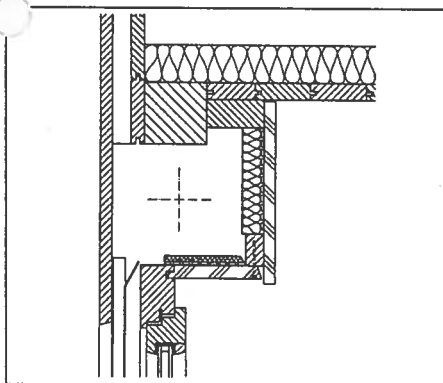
Schalltechnisch richtig ausgebildeter Rolladenkasten.
